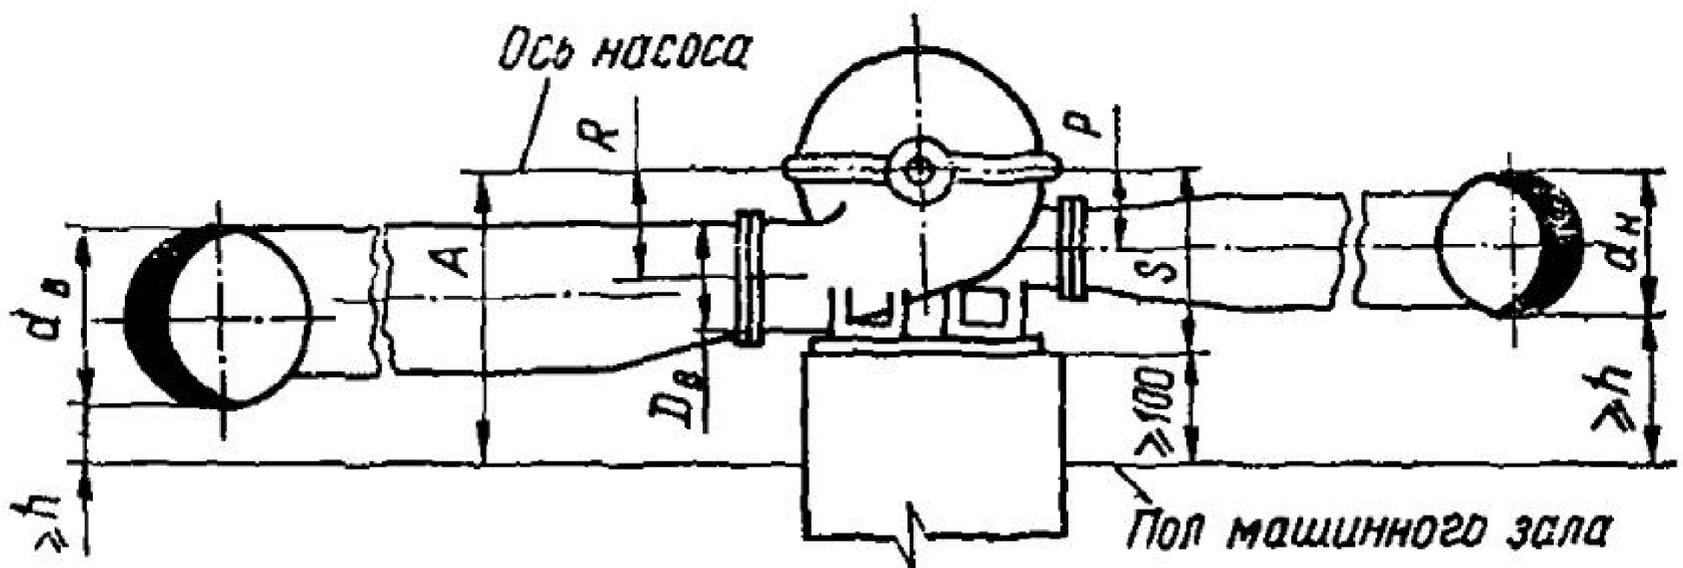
Схема к определению возвышения фундамента насоса над полом
